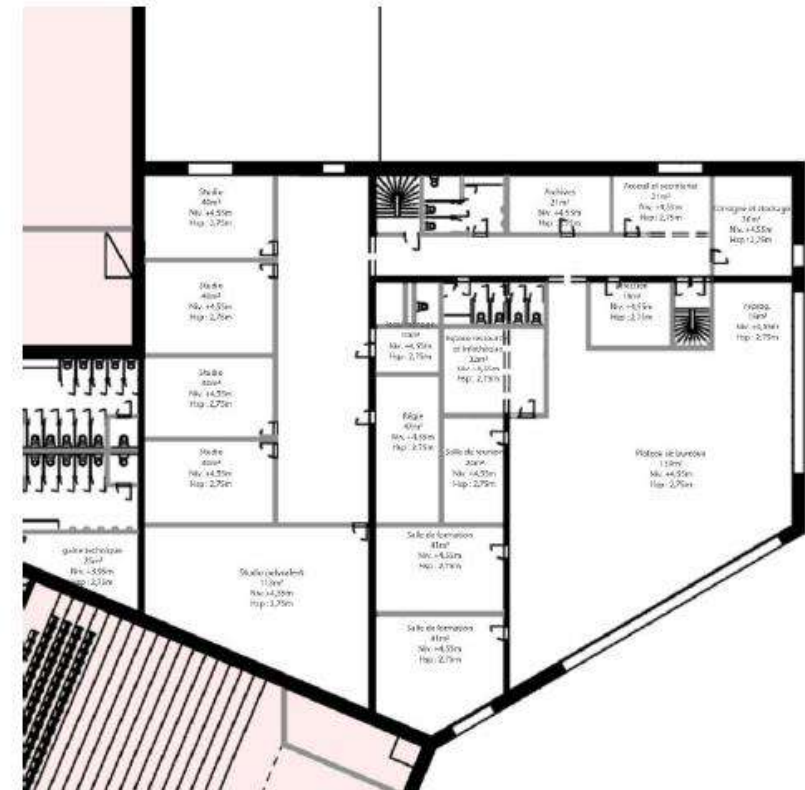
plan du R+1 où on retrouve l'espace d'attente devant les studios.
